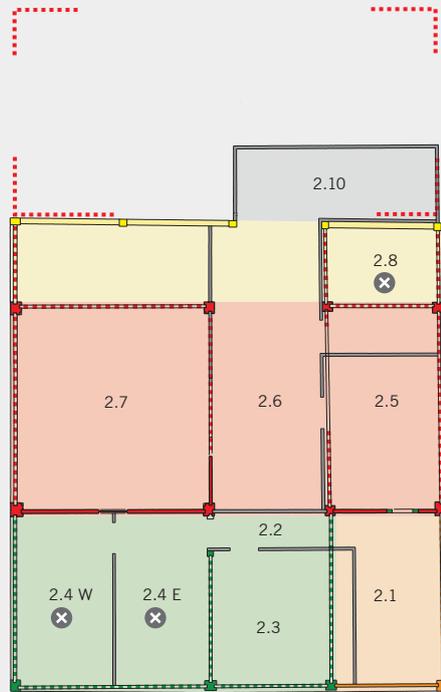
Baar, Rathausstrasse 6/8, Grundriss des zweiten Vollgeschosses.
